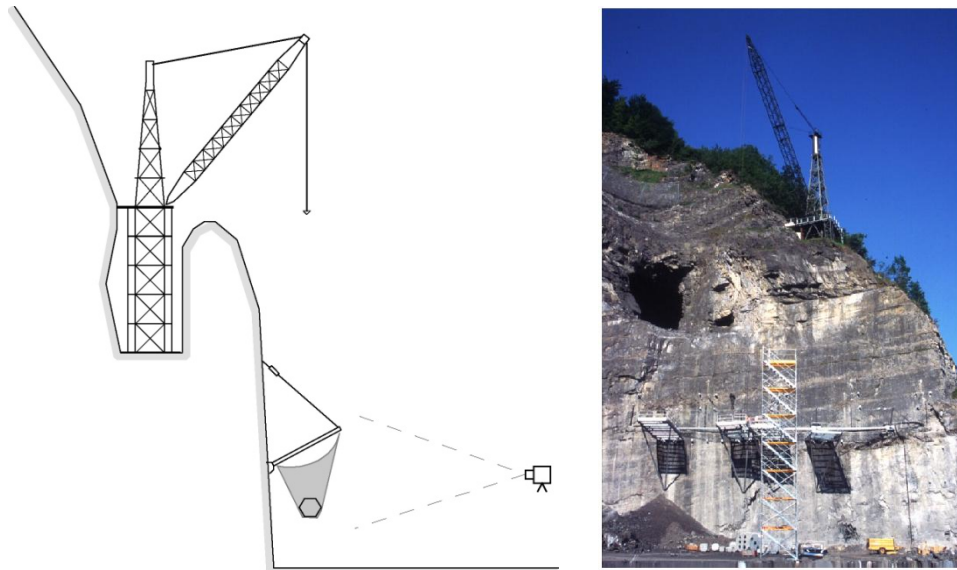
Site d'essais de Walenstadt en Suisse, [AND 02]
